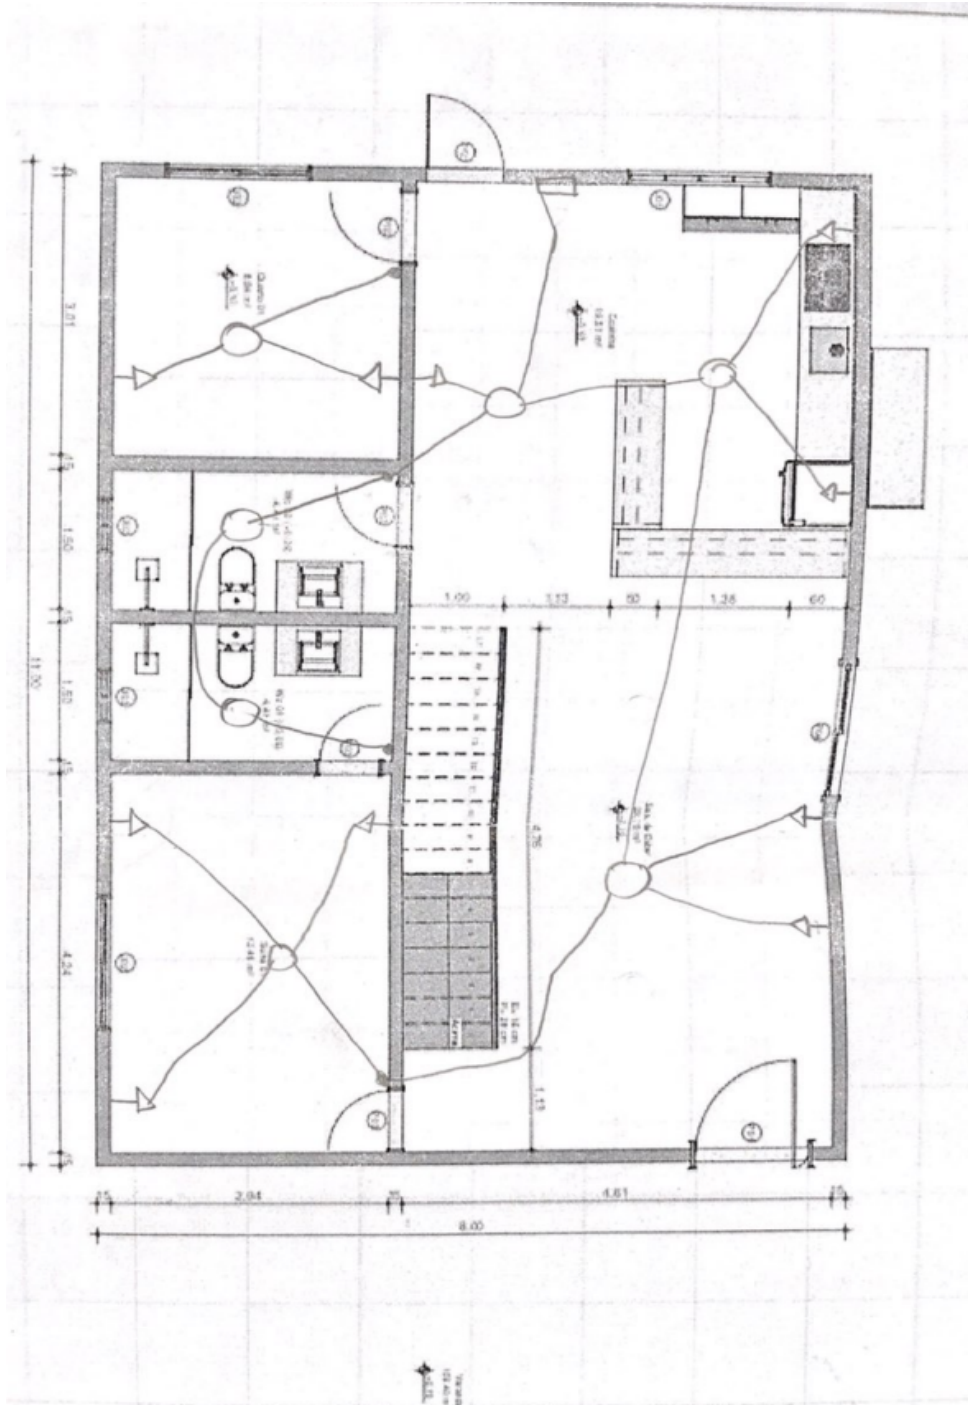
Planta baixa instalação elétrica pavimento térreo
